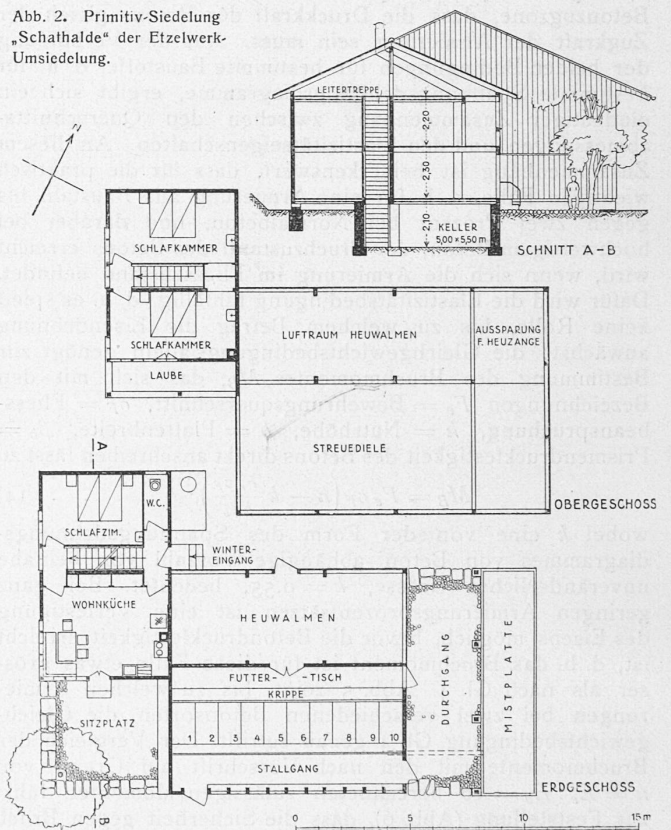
Schafhalde, Schnitt und Grundrisse 1 : 300.
